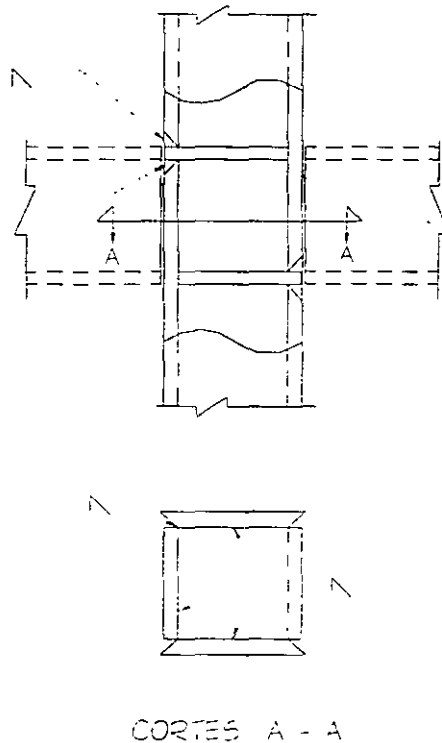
Colocación de atiesadores horizontales en una columna en cajón
